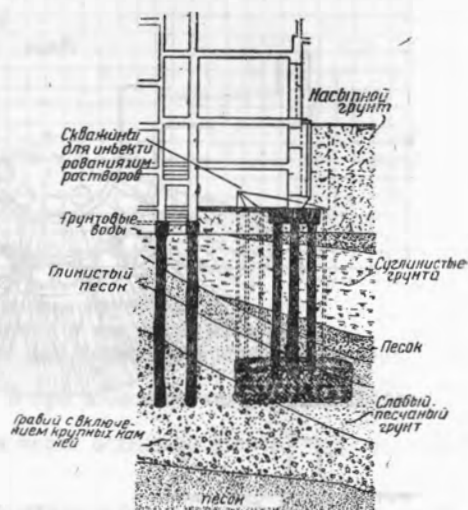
Химическое закрепление грунта в основании бетонных набивных свай.
